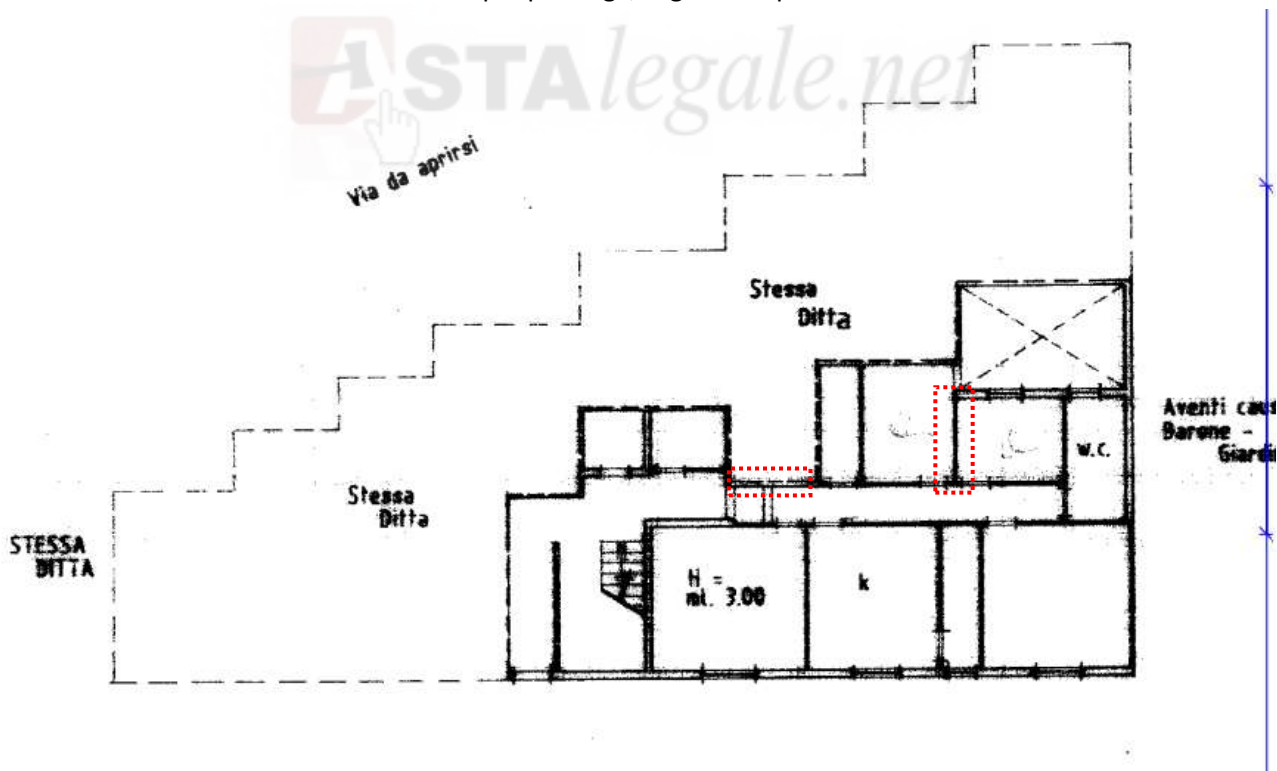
Lotto 1: Planimetria catastale con indicata la difformità rilevata
